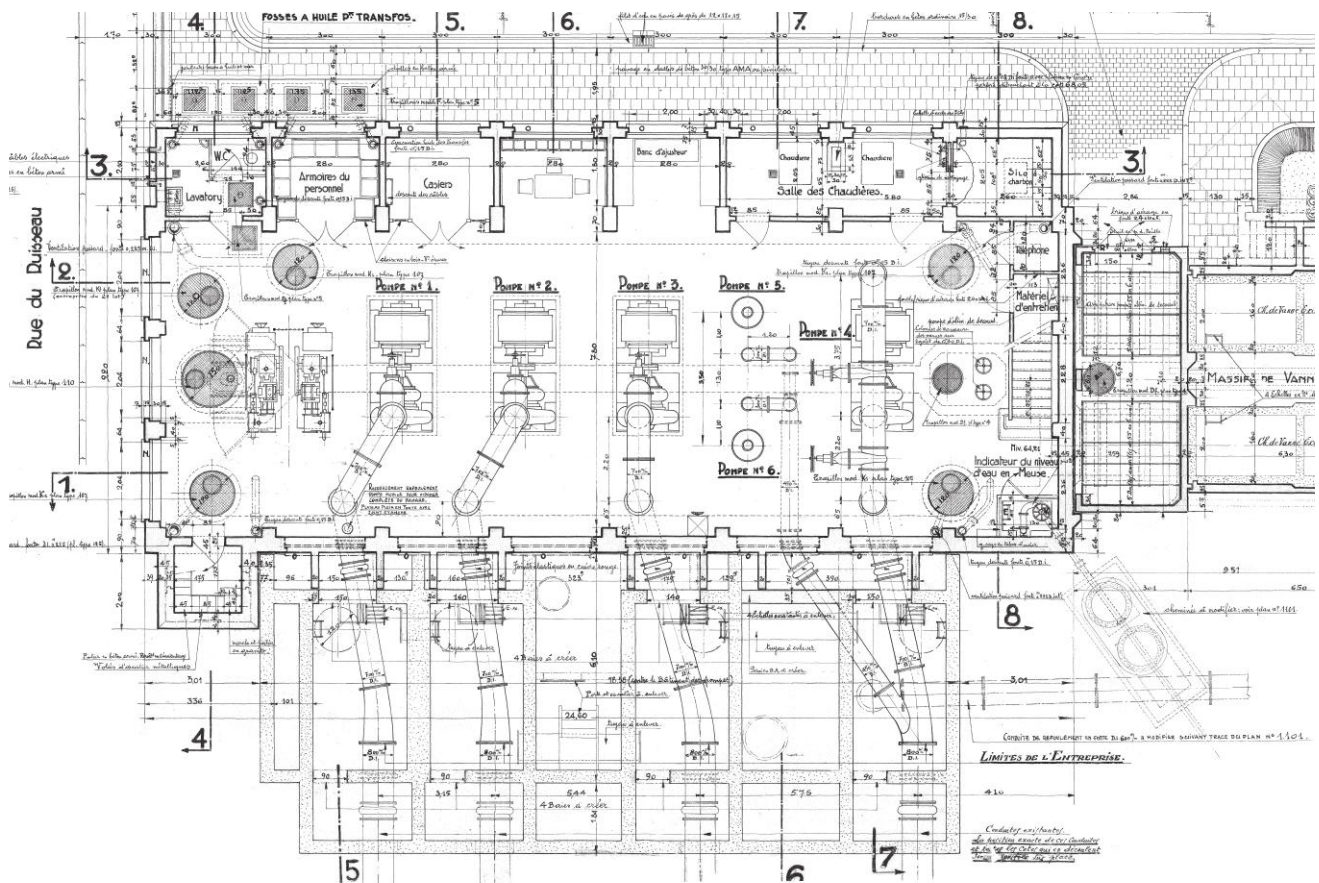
Plan du rez-de-chaussée existant et transformé – ech. 1/200
